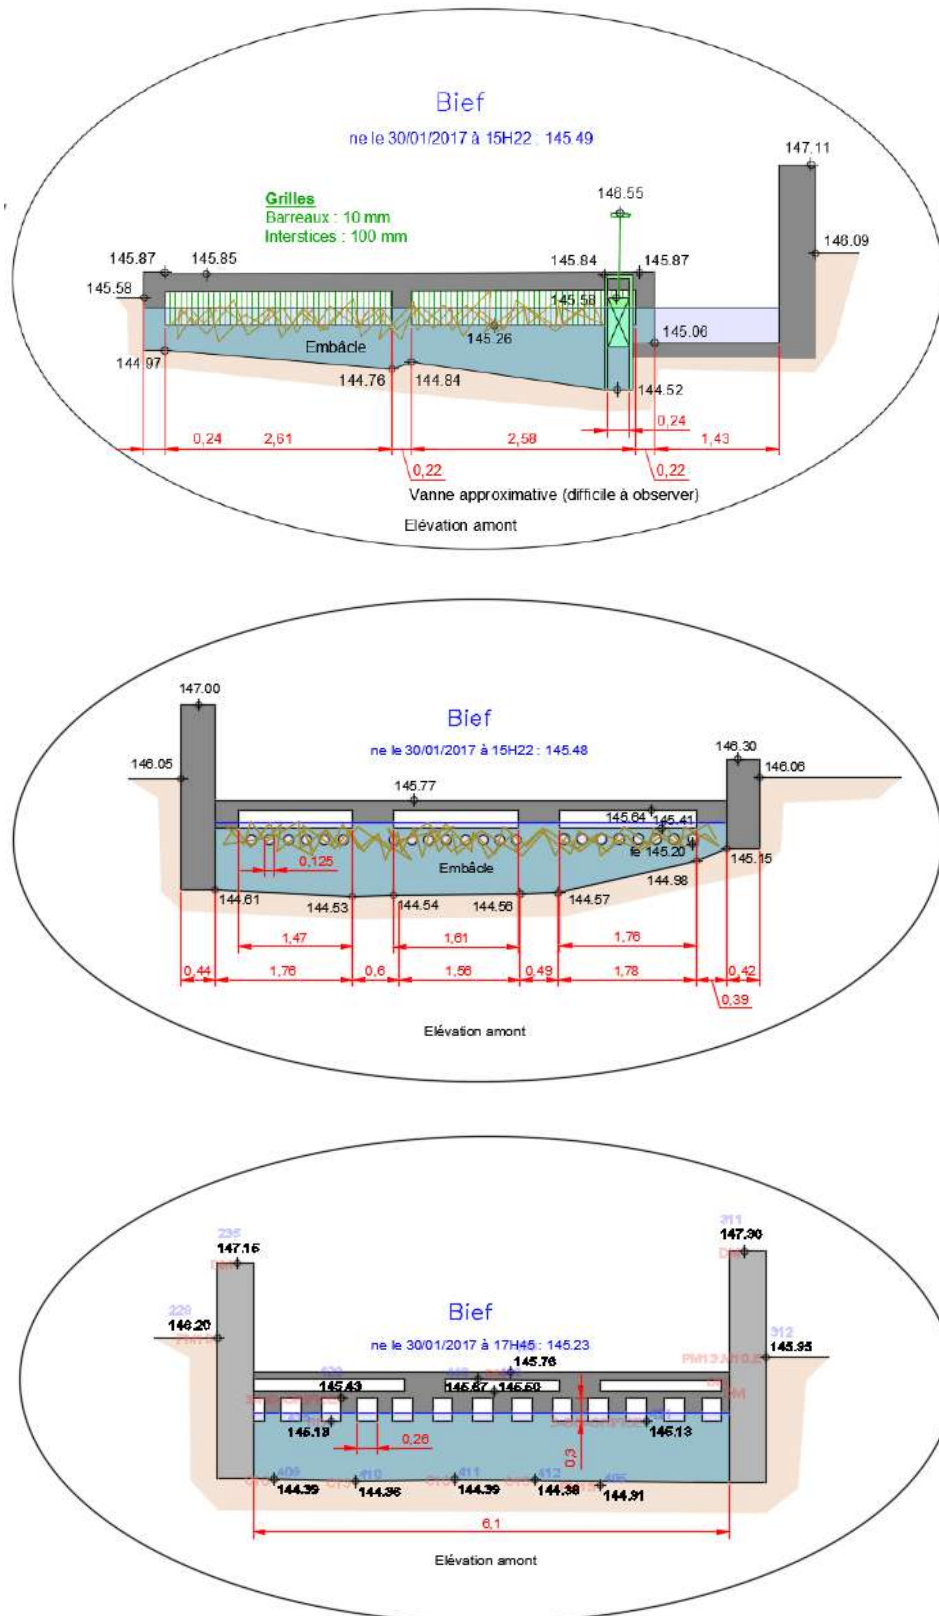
Vue et coupe transversale des ouvrages amont (d'amont en aval)
